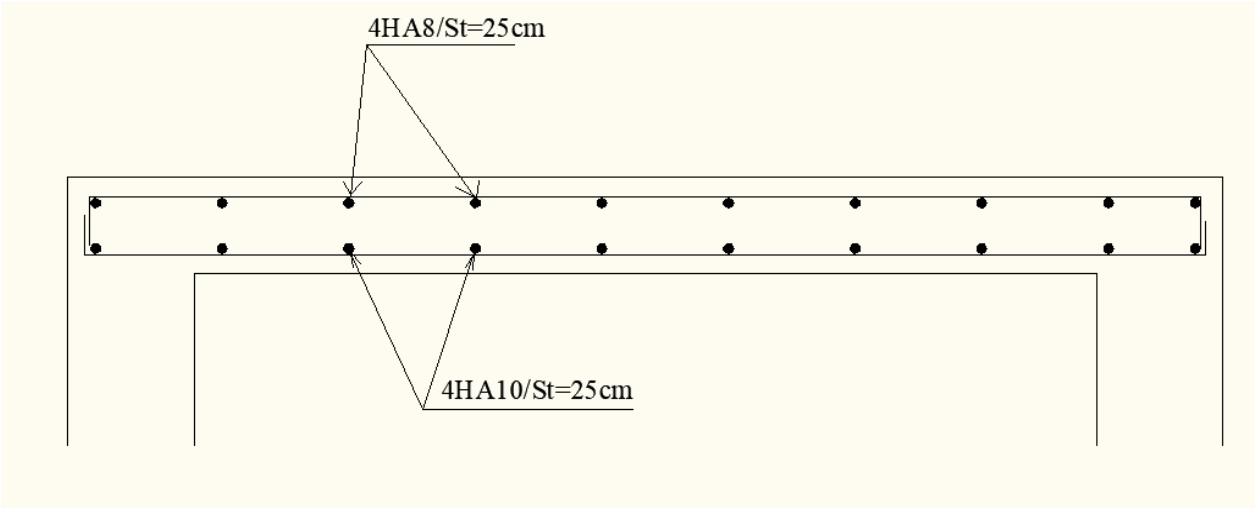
Plan de ferrailage de la salle machine suivant x-x.
